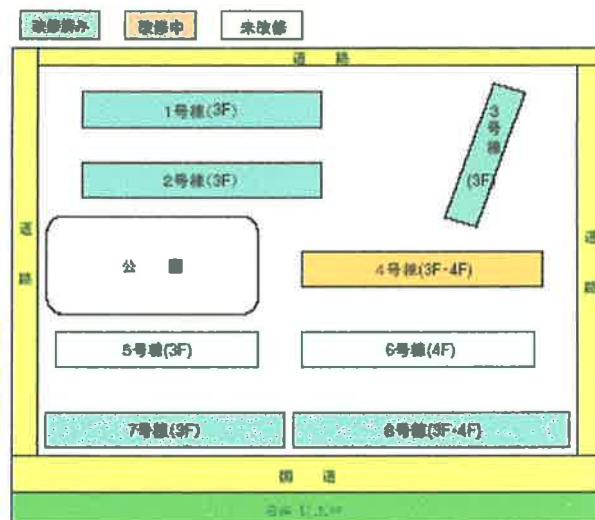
藤沢市営「鵠沼住宅」配置図
